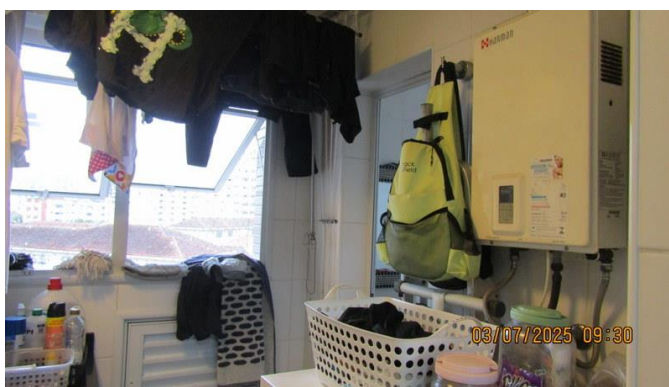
Outra vista da área de serviço do imóvel avaliando.
